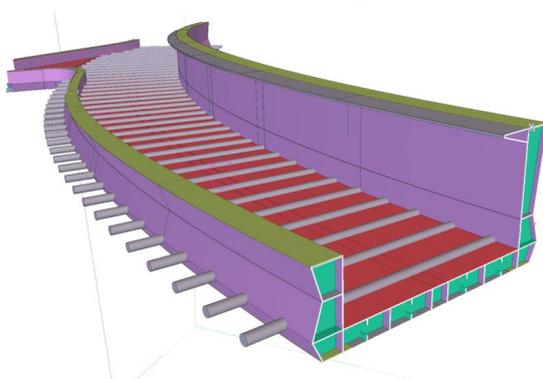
Modelo y plano de replanteo de la zona tres del tablero.
